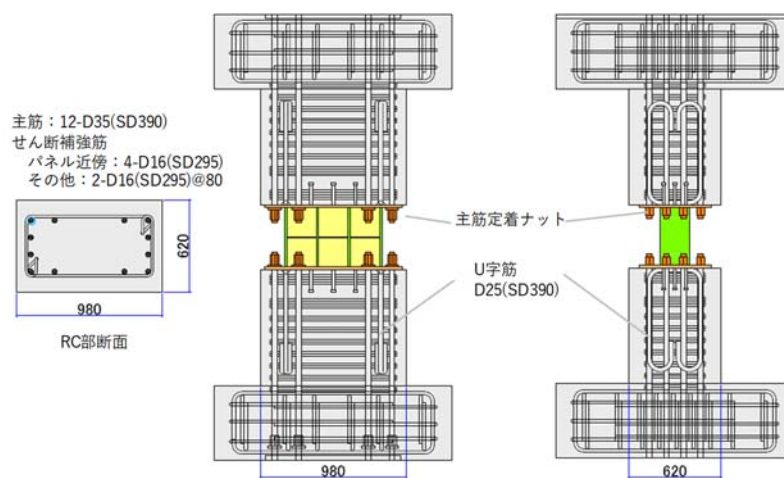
No.4 試験体, No.5 試験体の配筋詳細
